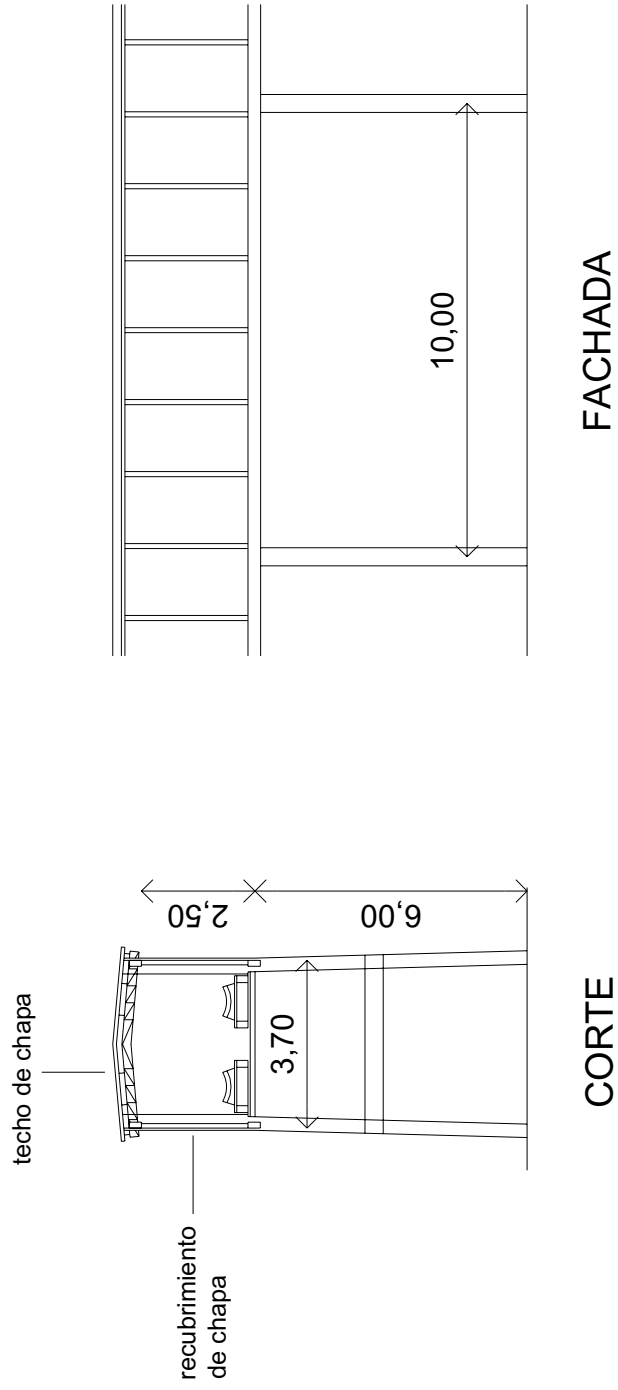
Plano de la Sección Transversal de la Cinta Transportadora para Envío de Carga
